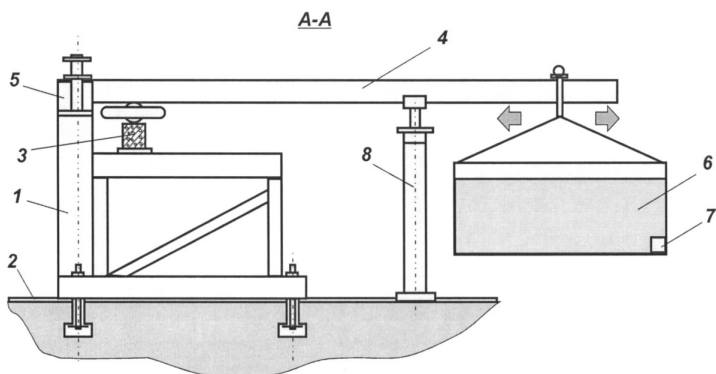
Сечение А-А на рис.1 (вид сбоку) [3], где: 1 – опора; 2 – силовой пол; 3 – балка (испытываемый образец); 4 – рычаги; 5 – опорные стойки; 6 – грузовая ёмкость; 7 – регулятор объёма и скорости; 8 – страховочный домкрат.
